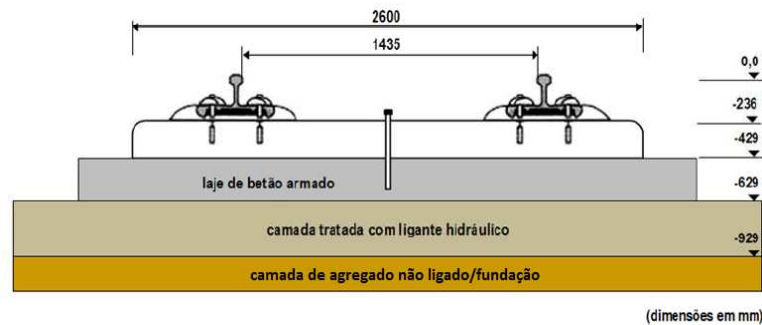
Perfil transversal esquemático de uma via em laje (adaptado de [148]).
